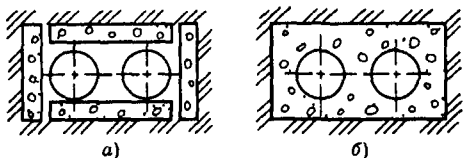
Разрез бесканального теплопровода в литом пенобетонном массиве
